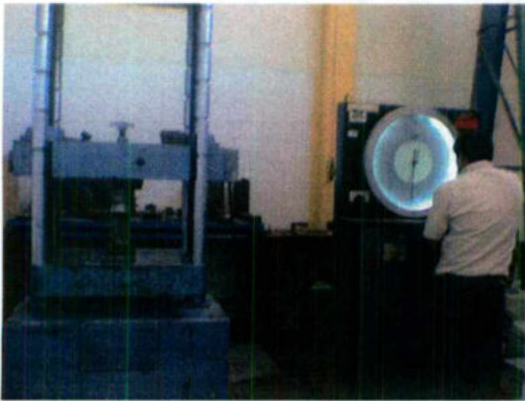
prueba de compresión a cilindros de concreto hecho en obra
